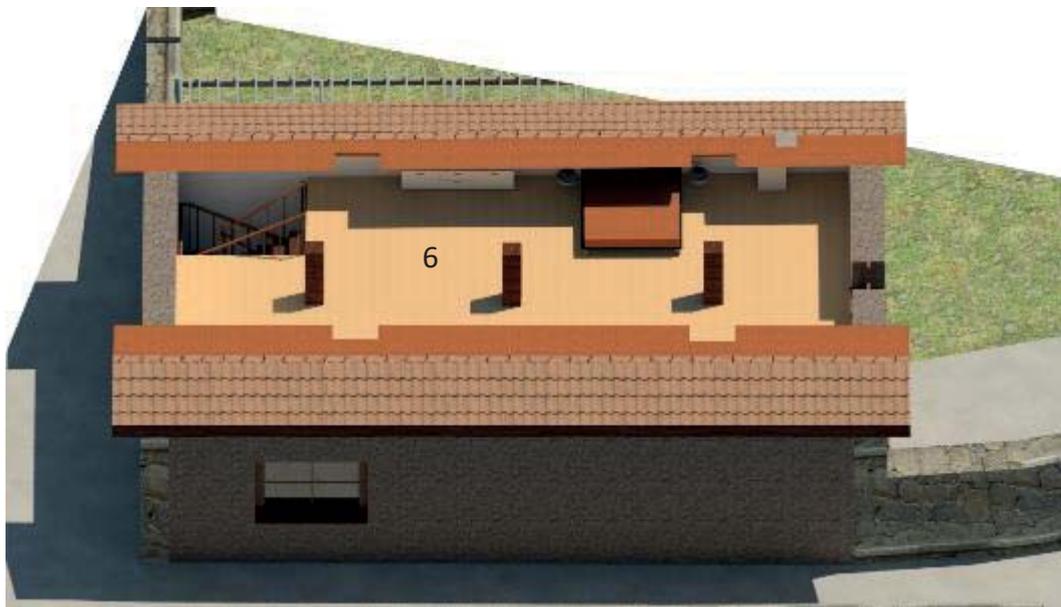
, Render Planta Primera Invernol. Fuente: propia
